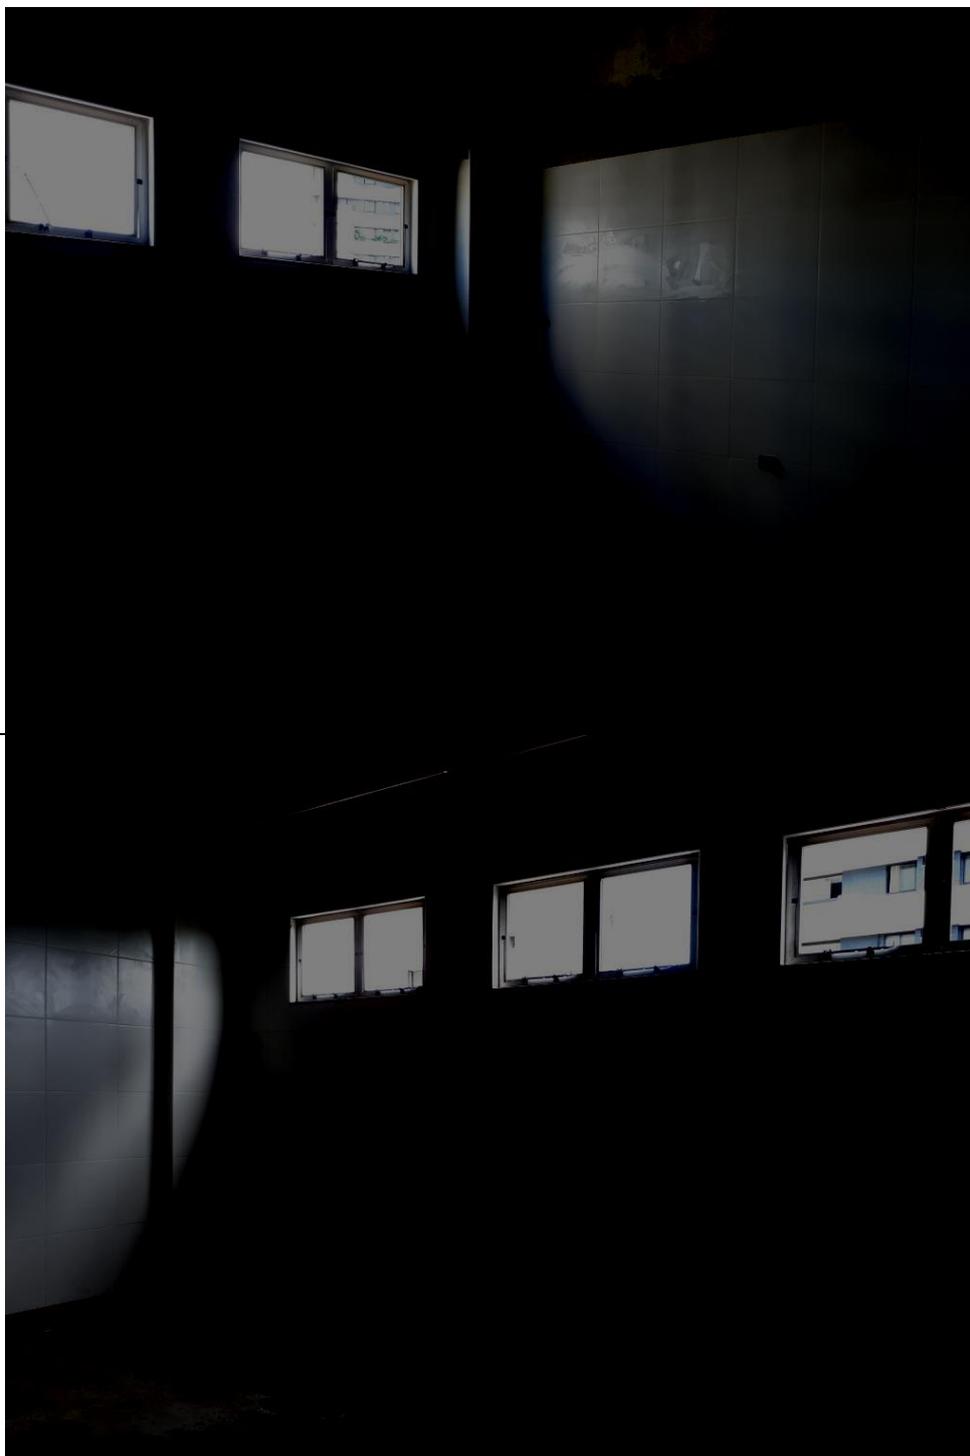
Vista interna do Sanit Fem. do terceiro andar. Alvenarias executadas e rebocadas.
